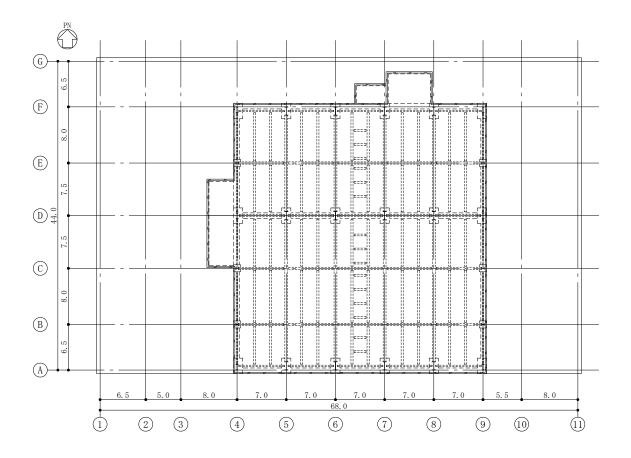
屋根平面図 (その2) (0.P.48.8) (単位:m)
